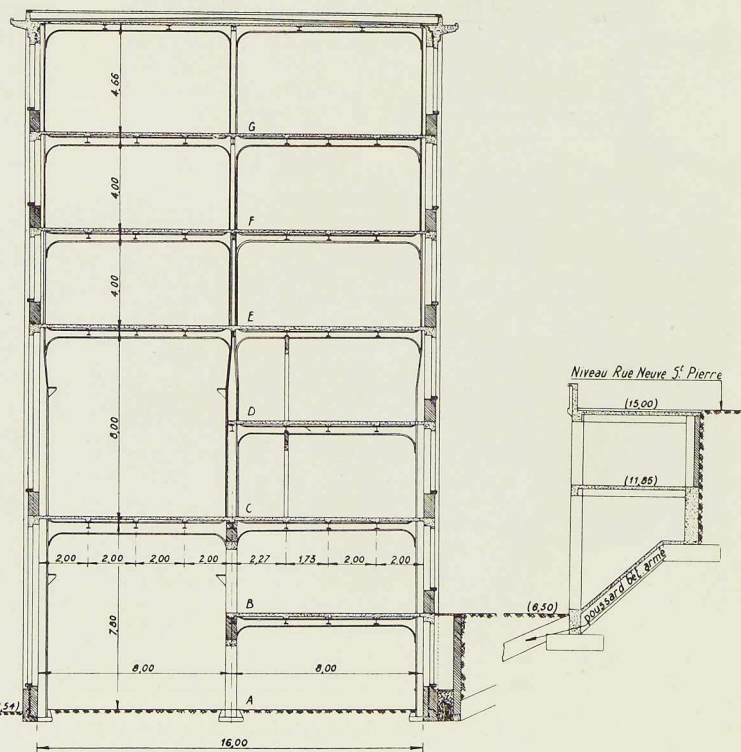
Coupe transversale montrant la disposition de l'ossature au droit des deux laboratoires équipés de ponts roulants.
